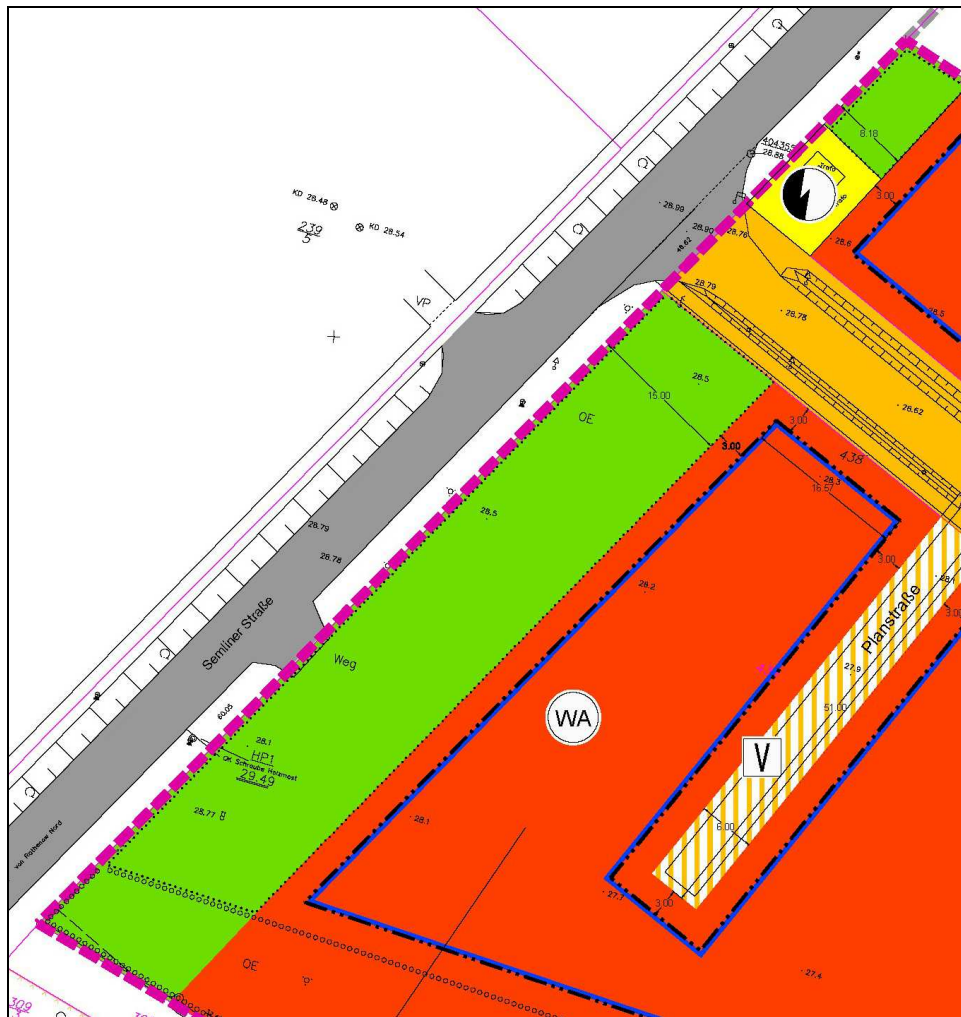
Lage der zukünftigen dauerhaft gesicherten Grünflächen am Westrand des Plangebietes; Grundlage Bestandsvermessung
